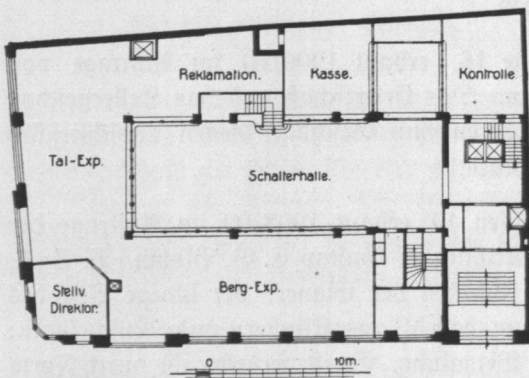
Haus Elbeschiffahrt, Erdgeschoss.
